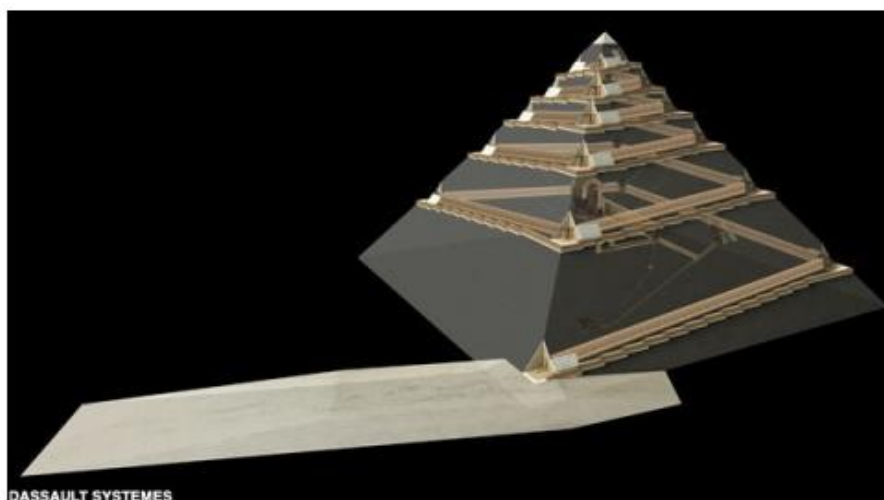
Два пандуса: внешний прямой и внутренний «штопорообразный» [5]
